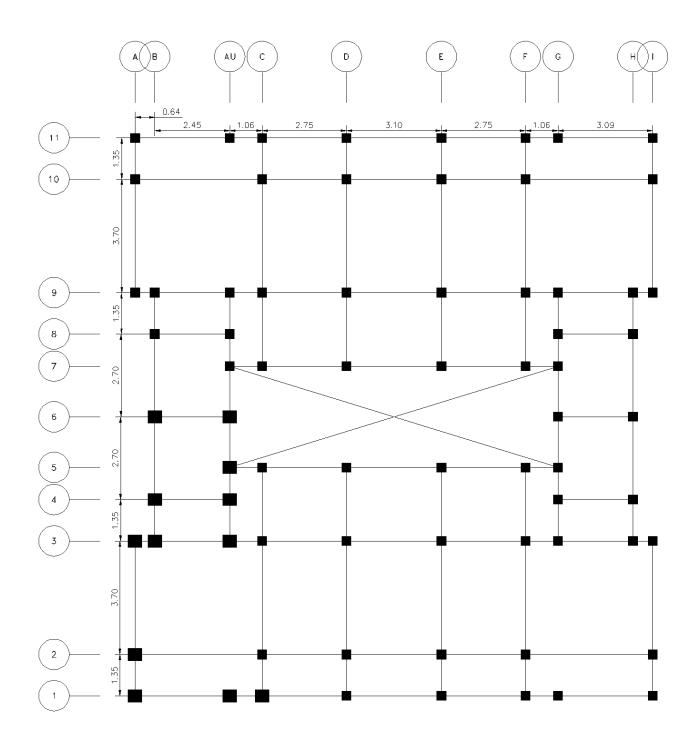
Plano estructural en planta de la vivienda residencial vis multifamiliar 12D
